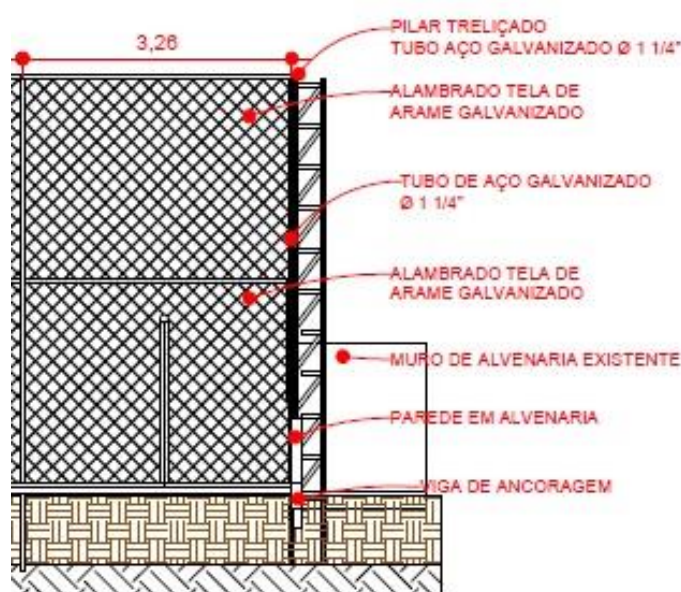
Detalhe de instalação do alambrado (Fonte: Autora/2022)
